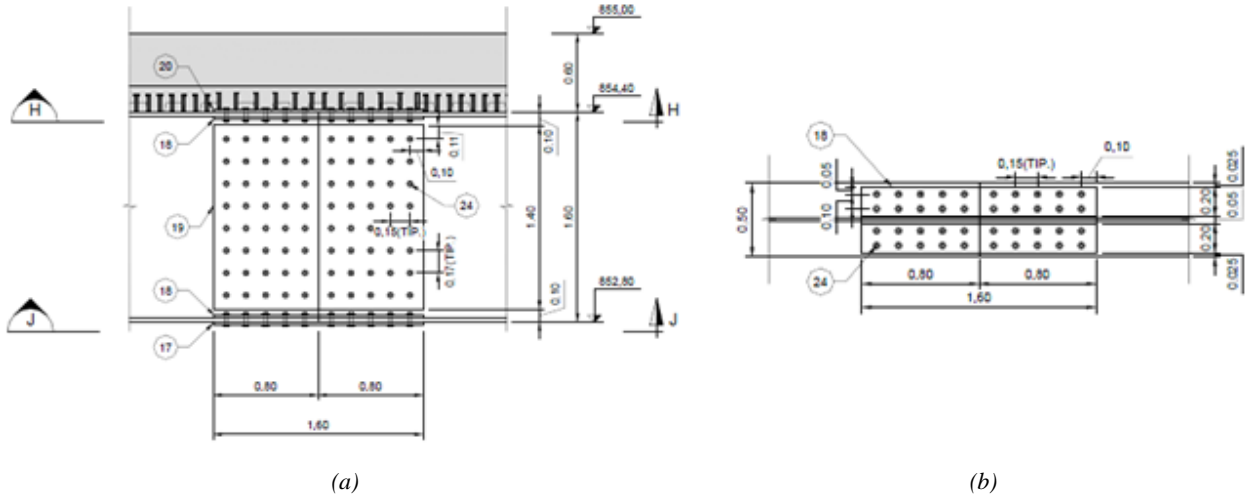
Empalme vigas principales- Puente de acceso - (a) Vista; (b) Planta
